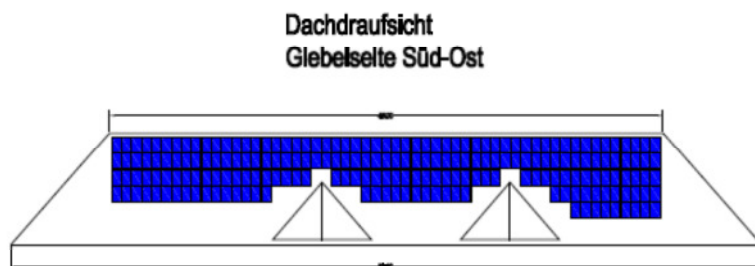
Dachaufsicht der geplanten PV-Anlage (Quelle: Techn. Beschreibung EPG, 16.12.2011)
